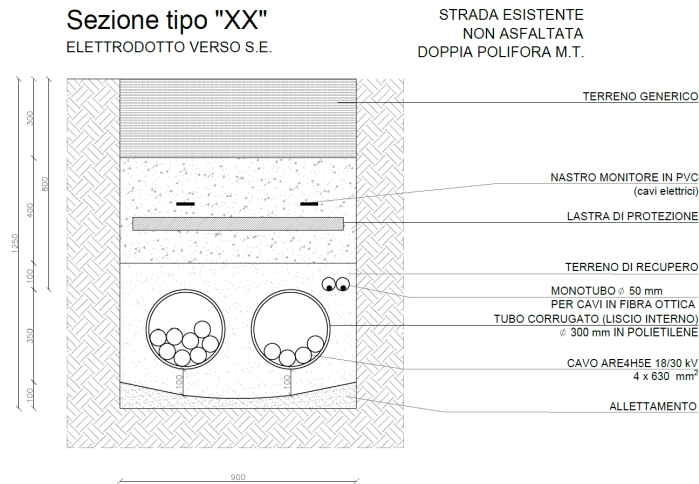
Sezione tipo X del cavidotto esterno MT verso SE
